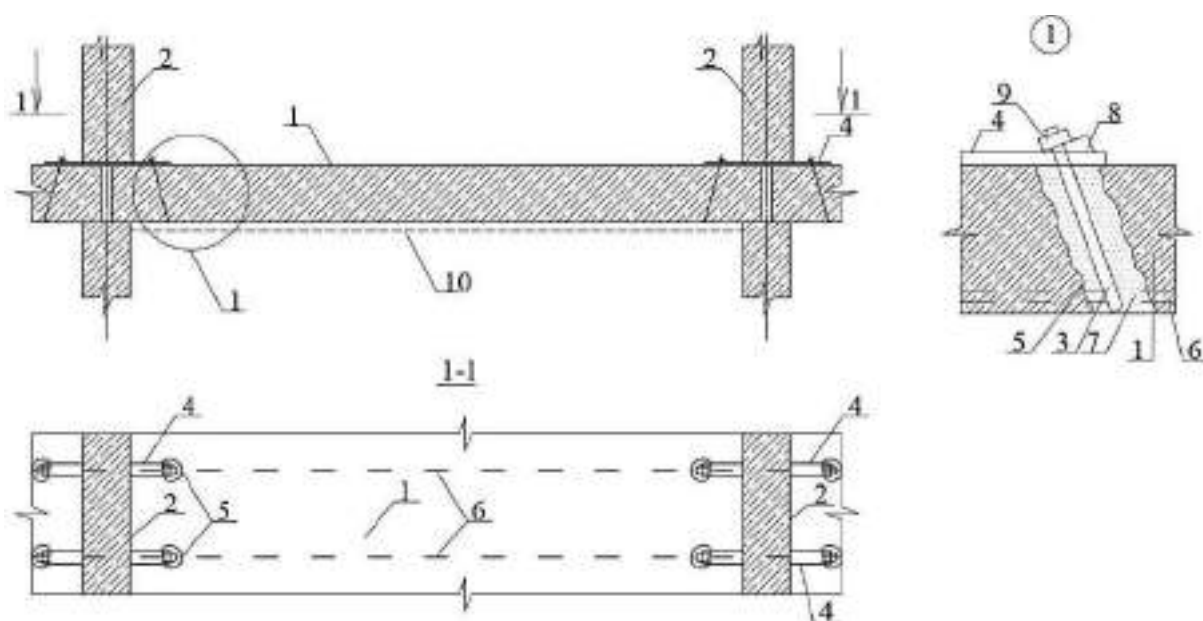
Установка надпорных скоб-коромысел и наращивание из фибробетона:
